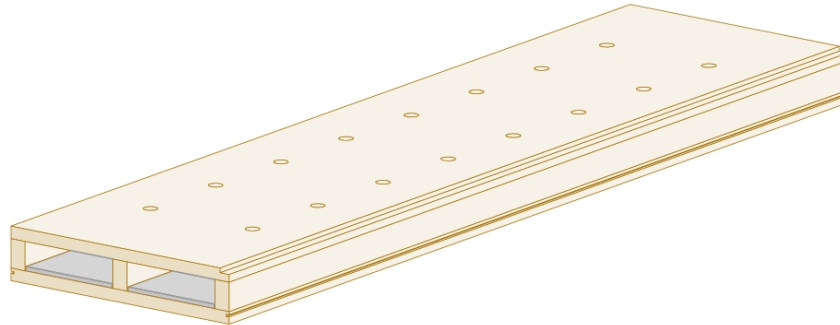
geschlossenes Hohlkastenprofil „best wood CLT BOX“
